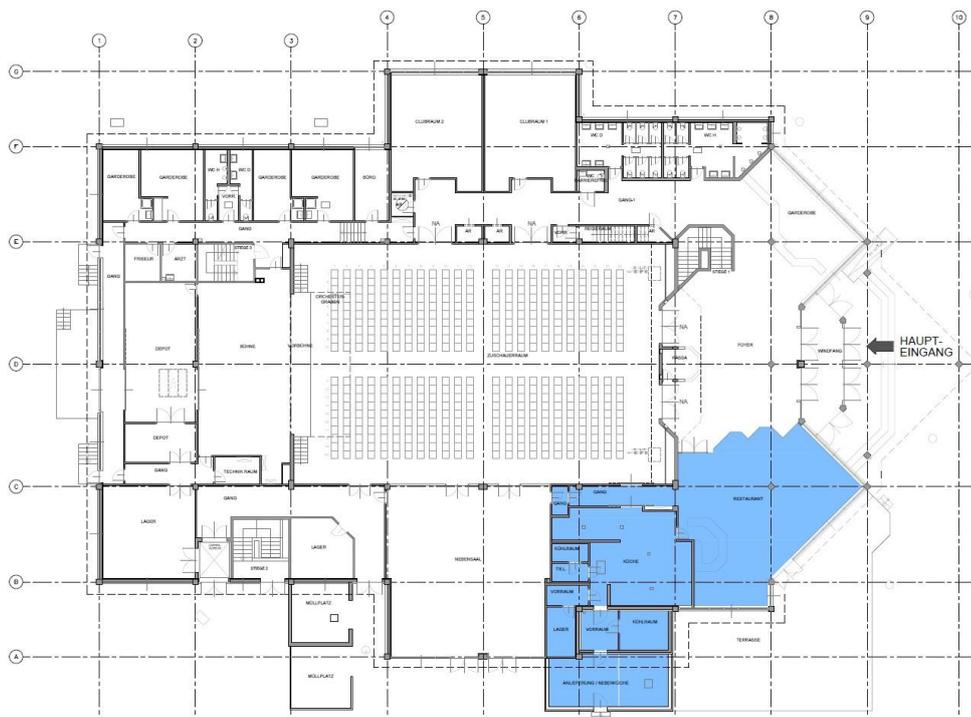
Übersichtsplan Erdgeschoß – Restaurantbereich
